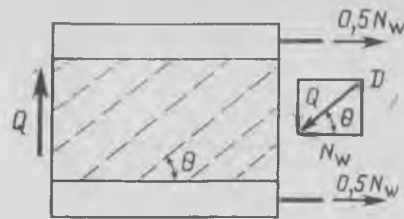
Схема расчета дополнительных усилий в продольной арматуре
